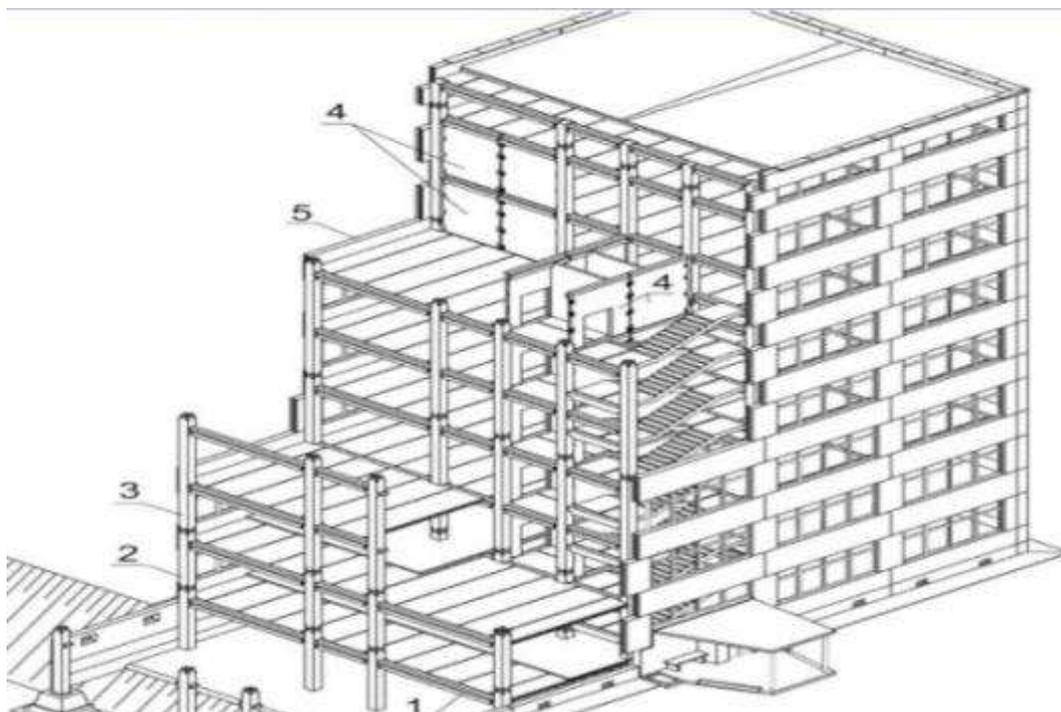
Конструктивне рішення типової багатопверхової промислової будівлі: 1 – перекриття; 2, 3 – колони; 4 – вертикальні діафрагми жорсткості; 5 – навісні стінові панелі
